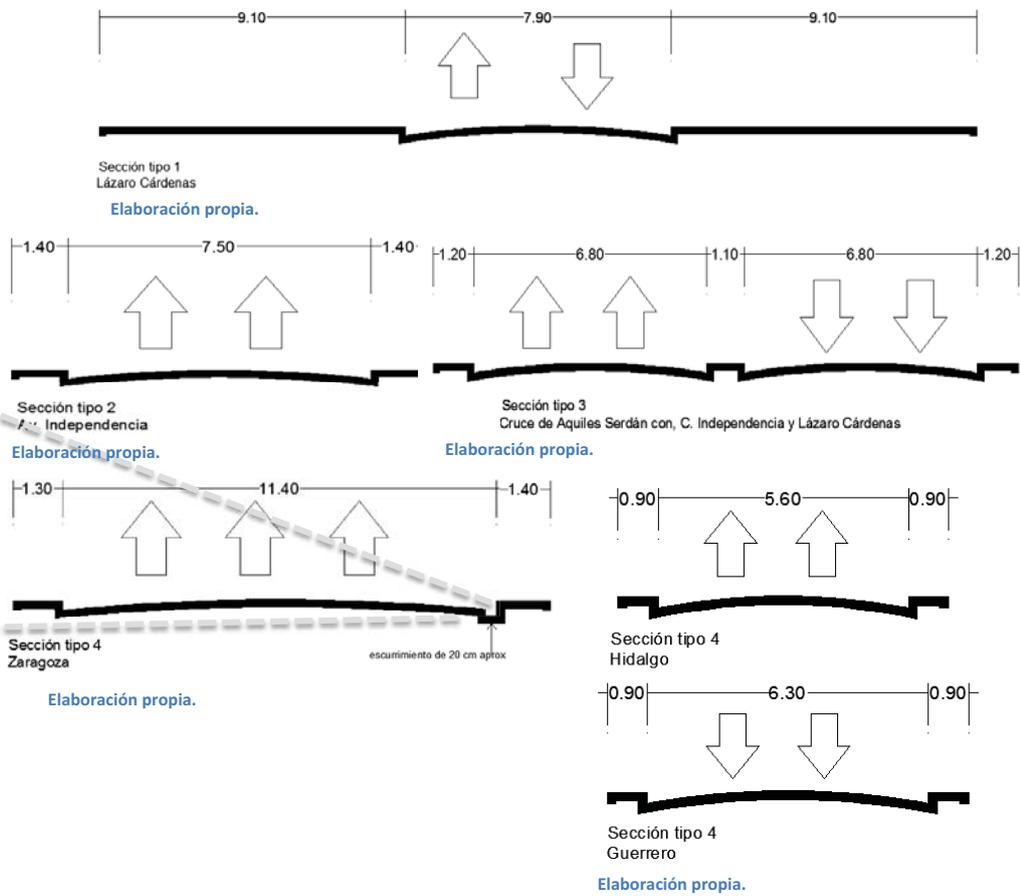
Estado de las vialidades con pavimento de adoquín. Elaboración propia.
